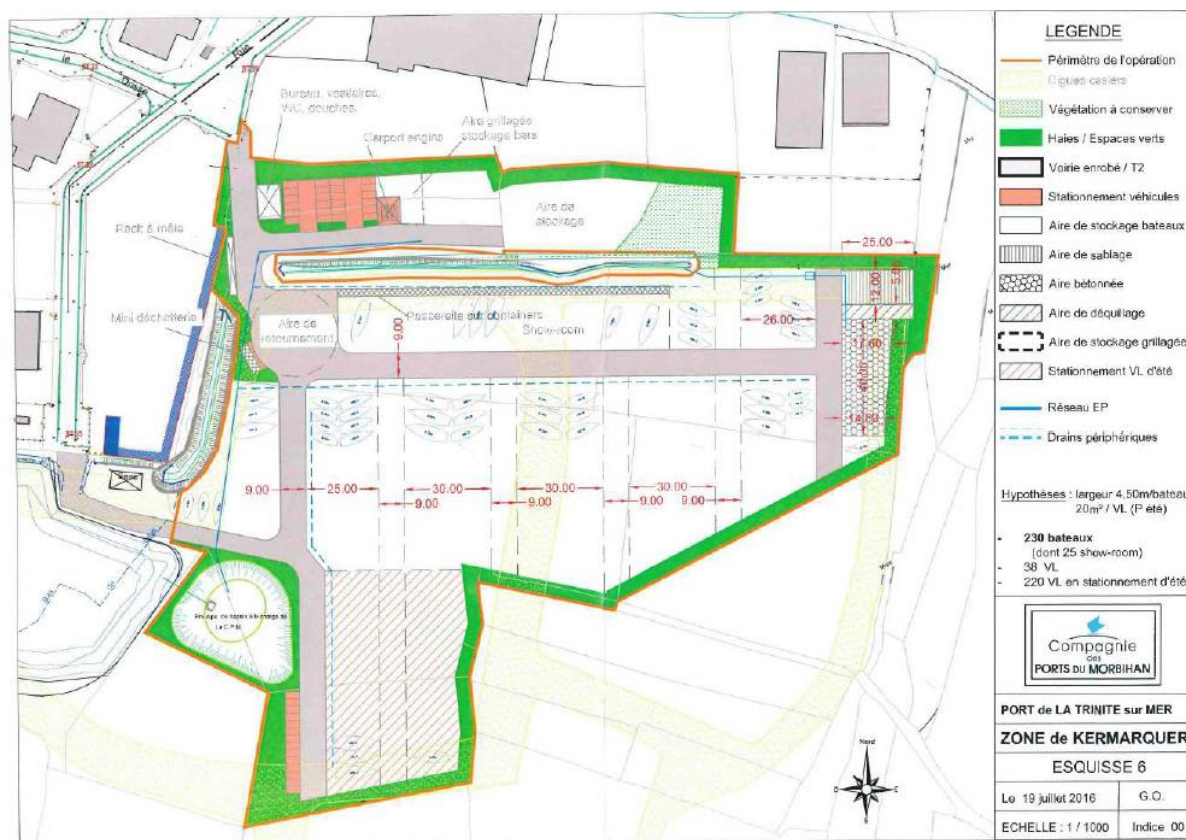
Plan projet de l'extension sud (CPM, juillet 2016)
